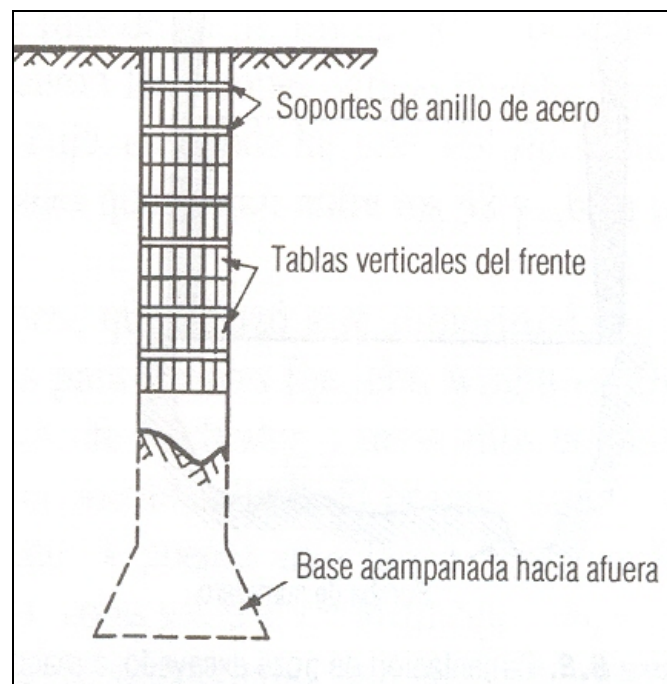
Construcción de Cimentaciones Profundas con pilas por el Método Chicago
